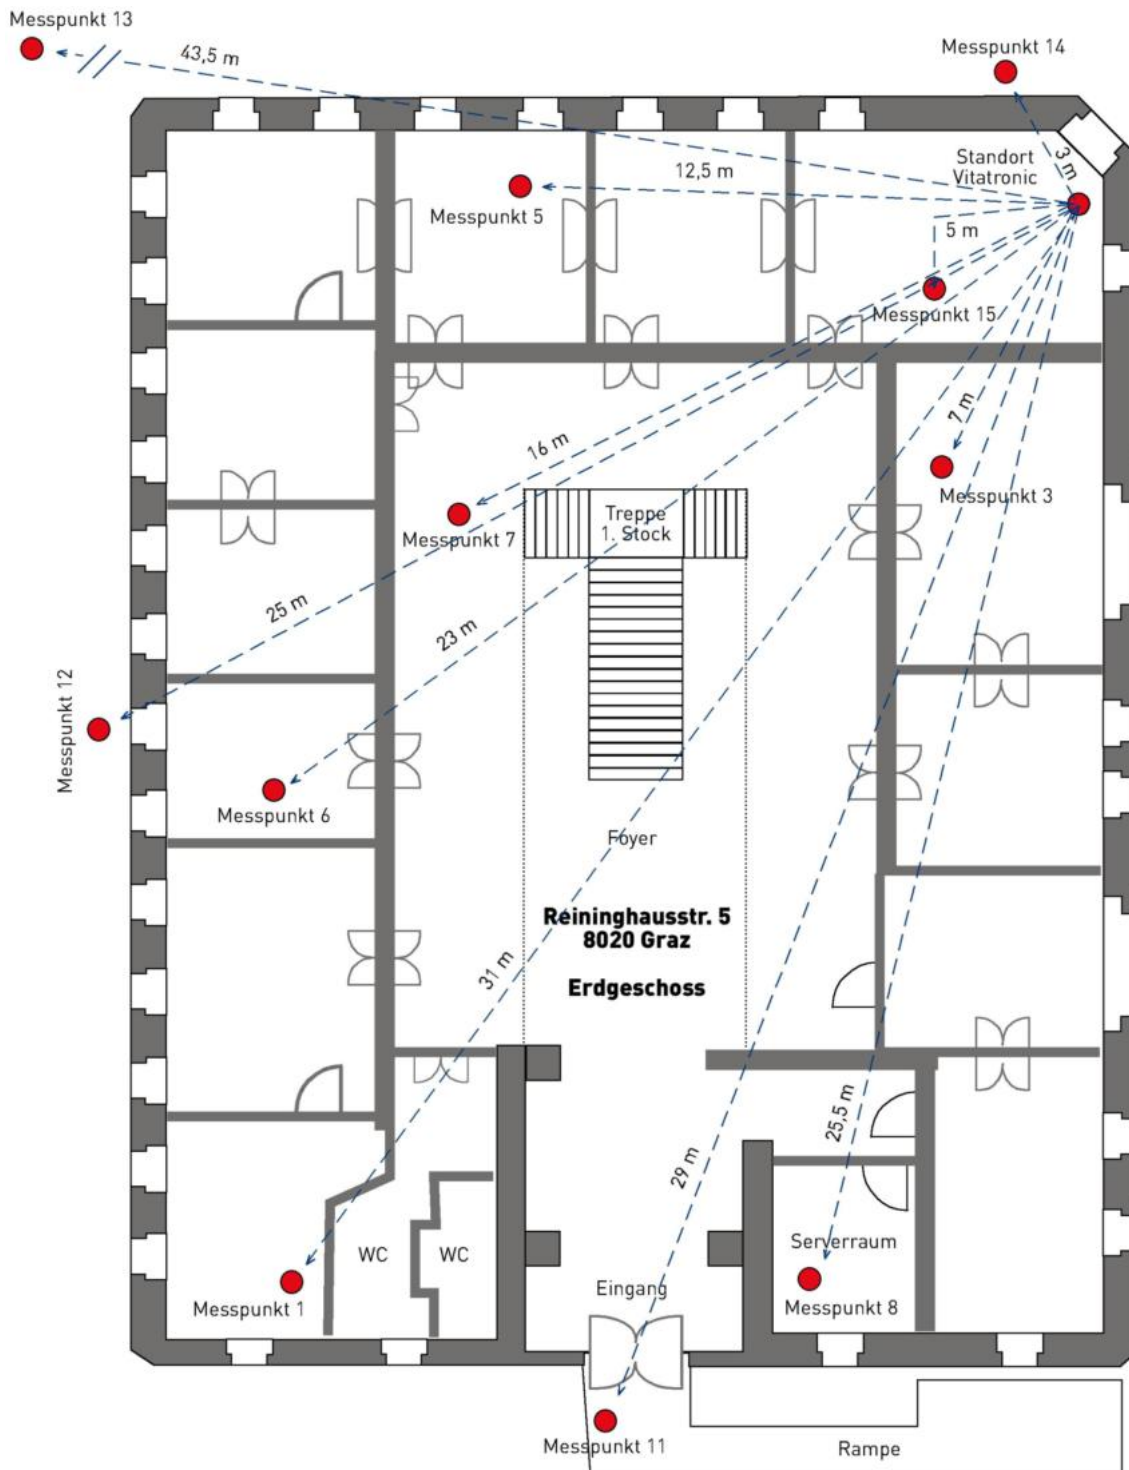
Erdgeschoß des Gebäudes mit Messpunkten (Grundriss)
